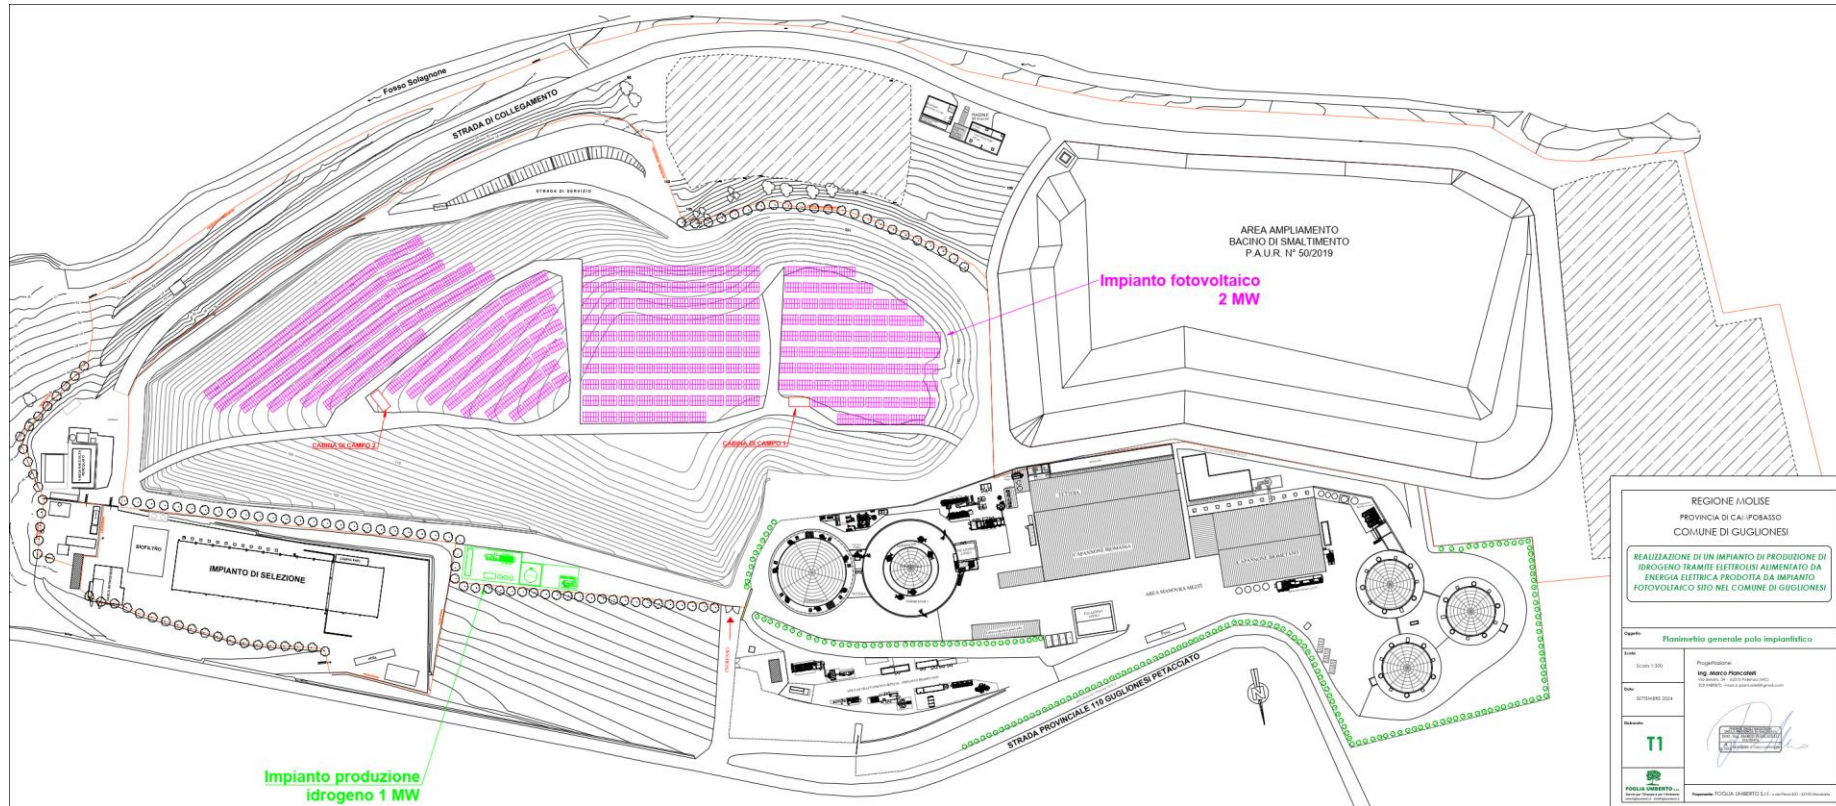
planimetria generale del polo impiantistico di trattamento rifiuti di GUGLIONESI
